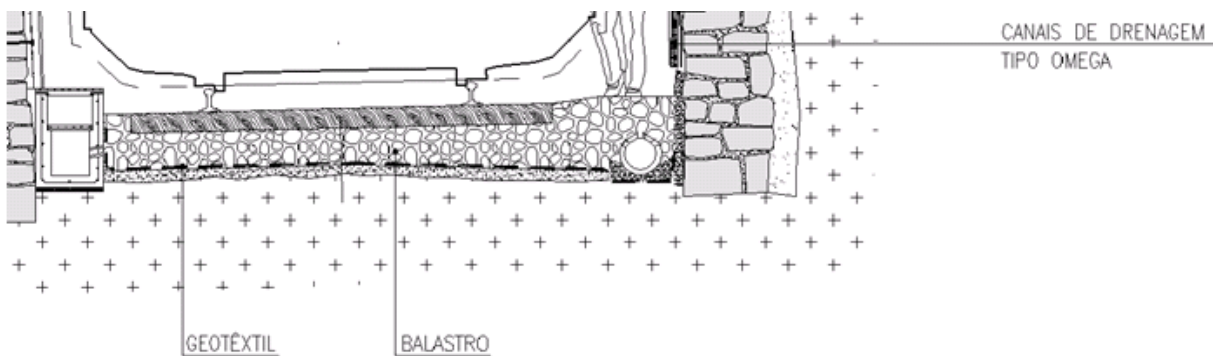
Pormenor1 de canais de drenagem (adapt. de GEG)
